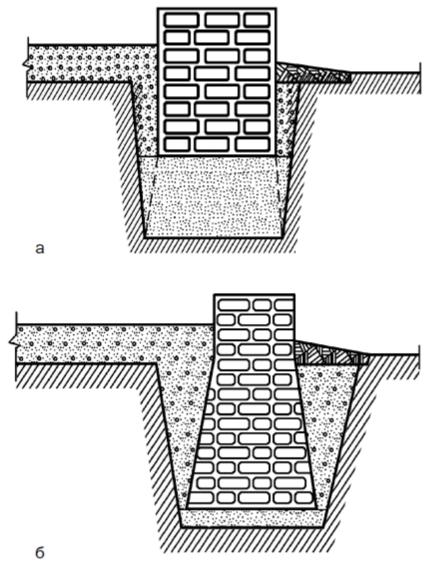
Бутобетонный фундамент: а – в непучинистых грунтах; б – в пучинистых грунтах
